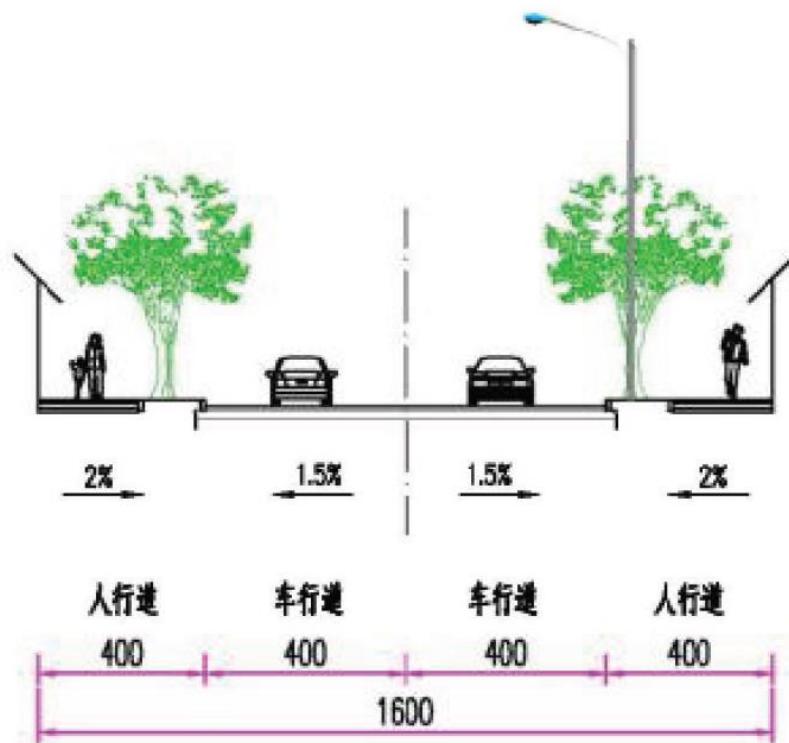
复兴路连接线道路标准横断面图 (16m)
